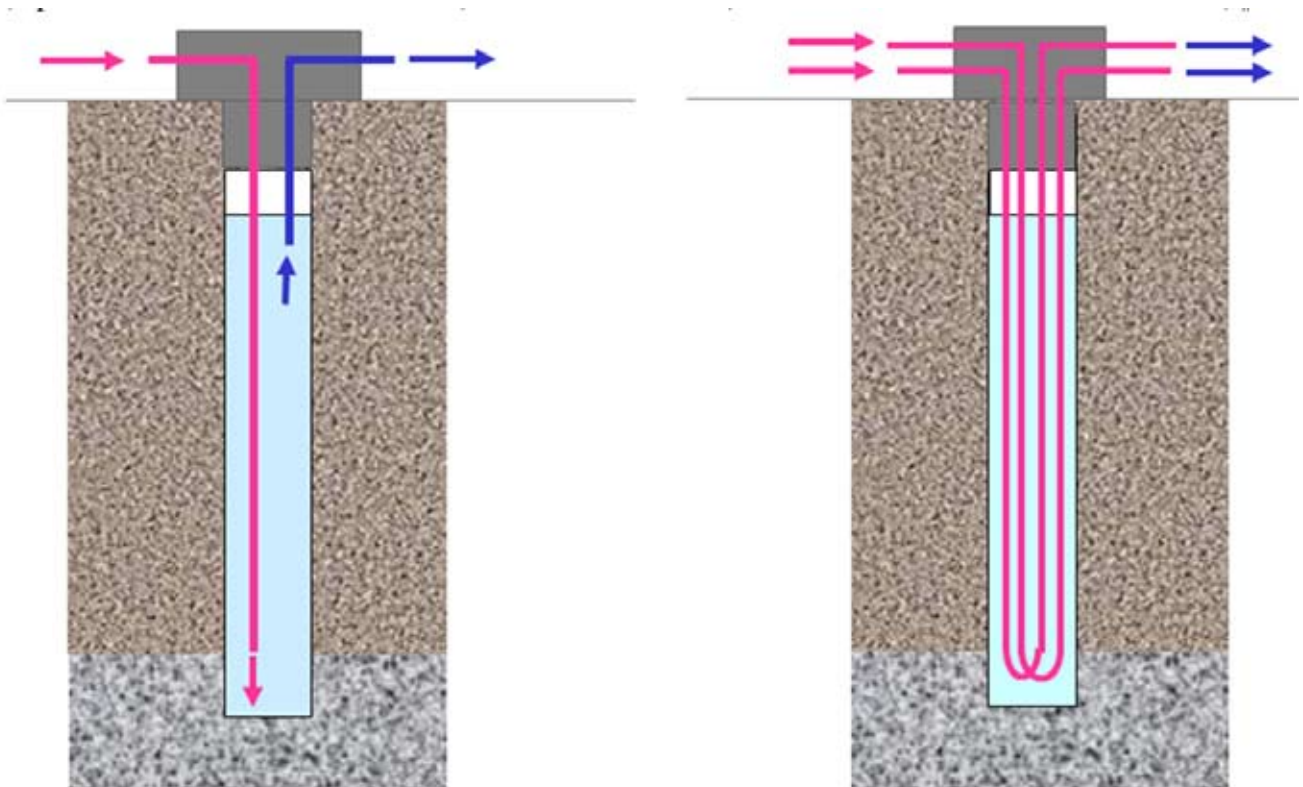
Использование строительных свай для фундамента здания в роли теплообменников
